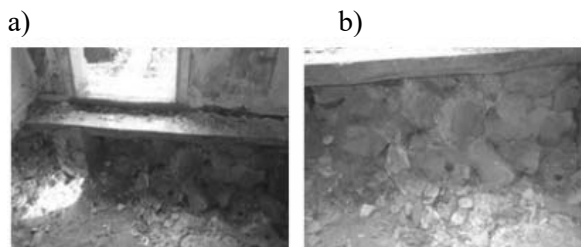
Кам'яні фундаменти будинку по вул. Курсанта Єськова в Чернігові: а - цокольна частина, b – фундамент.
